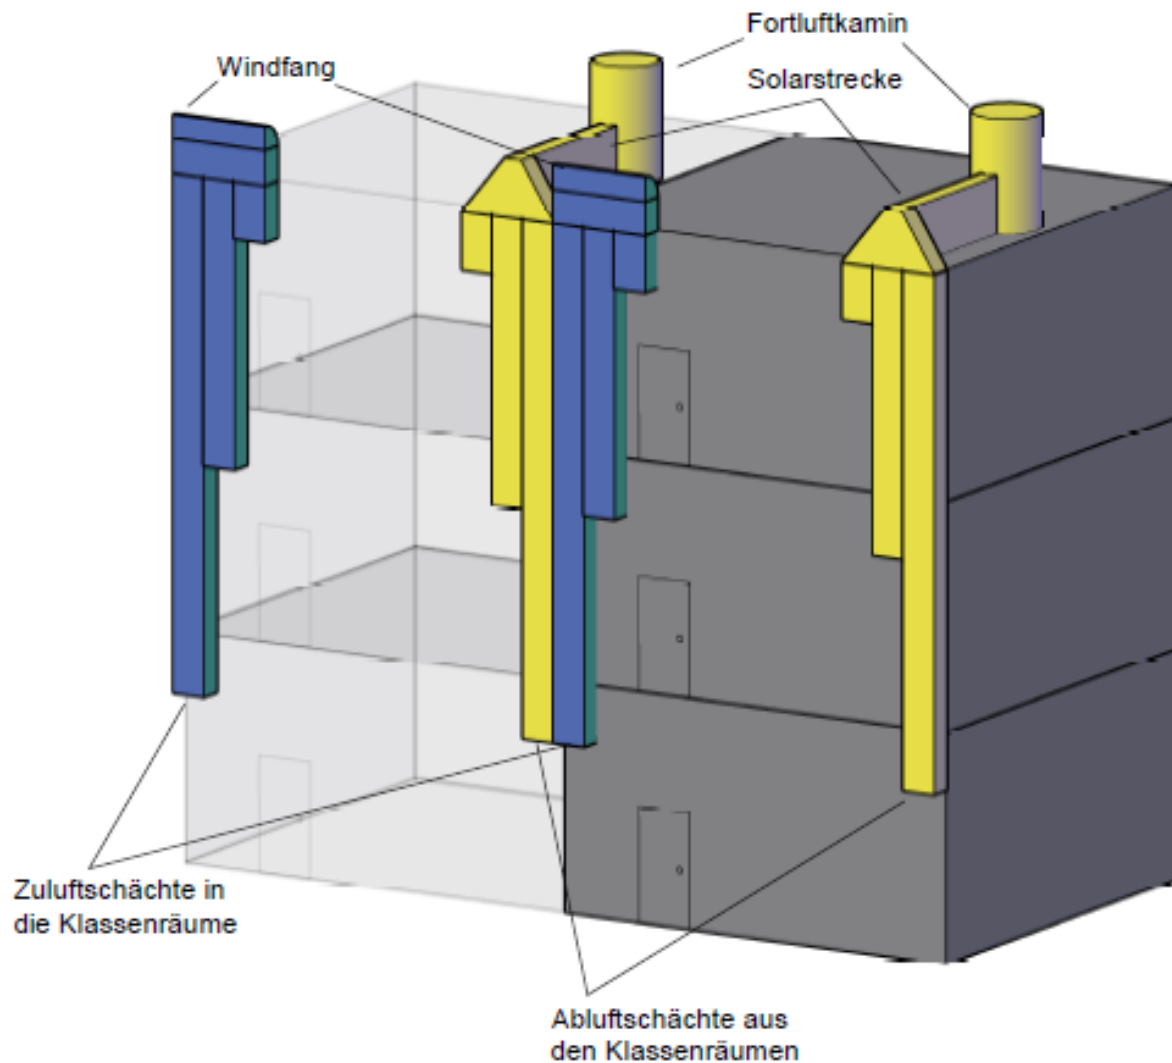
Erschließung über Windfänger am Dach, Schacht je Klasse an Innenwand
